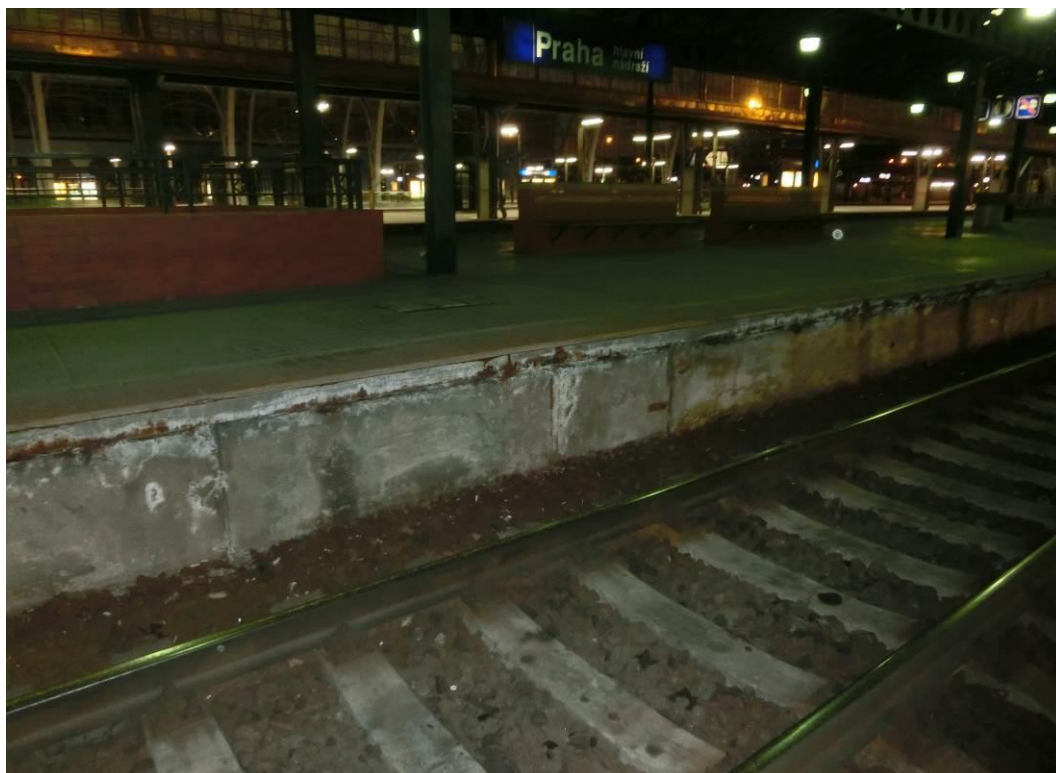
Detail koroze výztuže, degradace krycí vrstvy betonu
